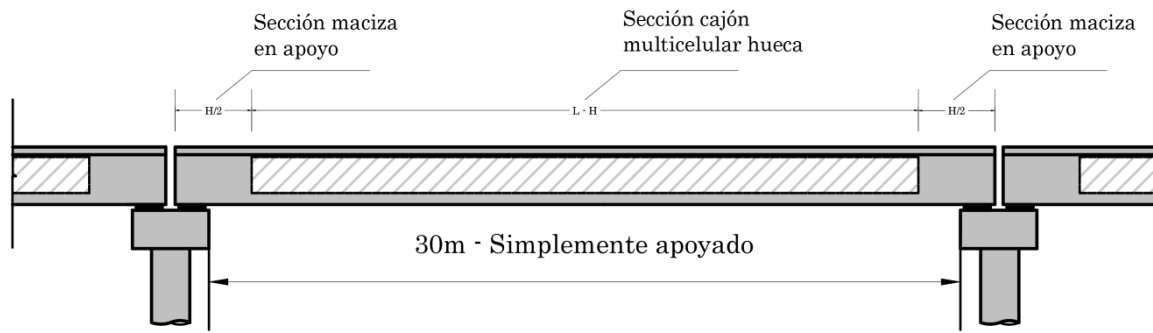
Vista longitudinal del puente del cado de estudio (Fuente: Elaboración propia).
